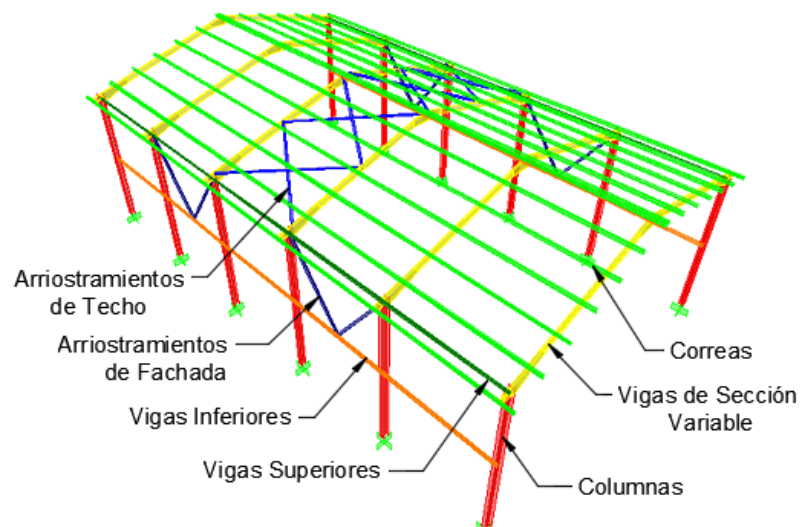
Miembros estructurales para Galpones con vigas de sección Variable.
